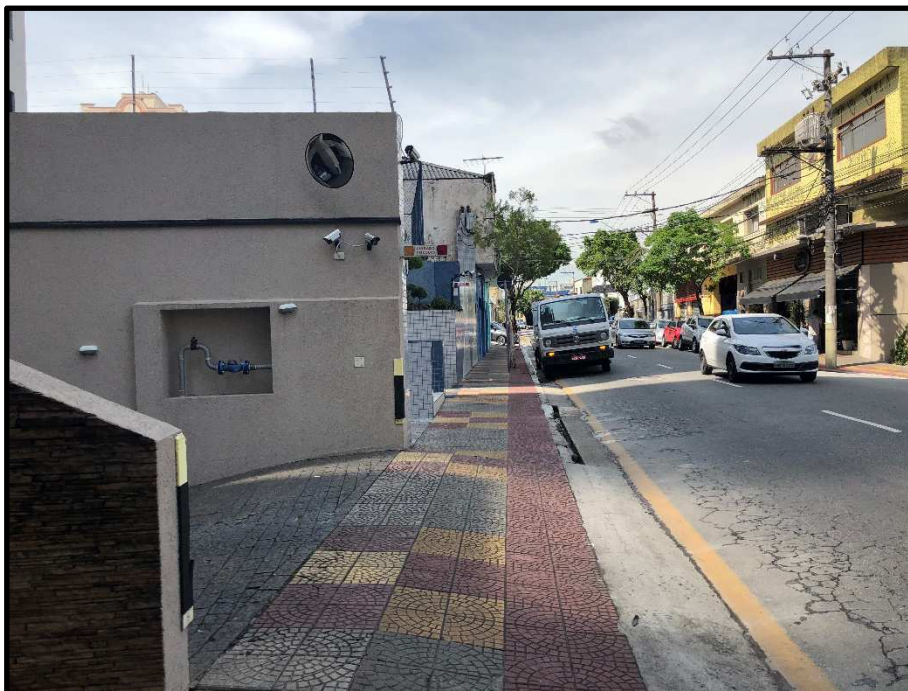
Avenida Roberto Simonsen – Vista Geral 1 do acesso
